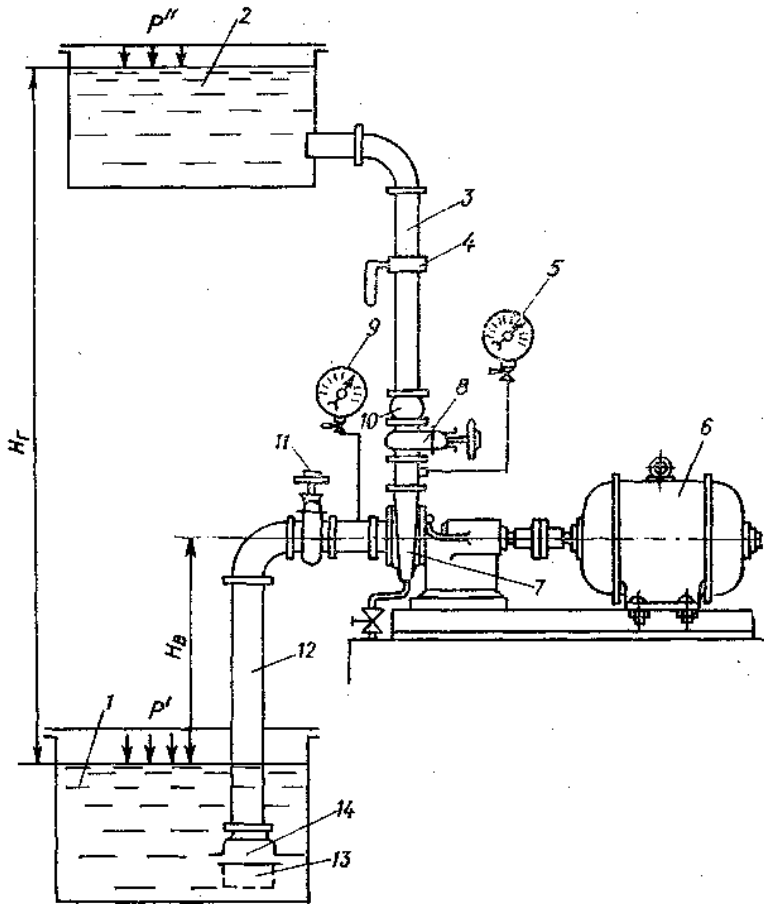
Схема насосної установки: 1 – приймальний резервуар; 2 – напірний резервуар; 3 – напірний трубовід; 4 – витратомір; 5 – манометр; 6 – електродвигун; 7 – насос; 8, 11 – засувка; 9 – вакууметр; 10 – зворотний клапан; 12 – всмоктувальний трубовід; 13 – приймальна сітка; 14 – клапан
